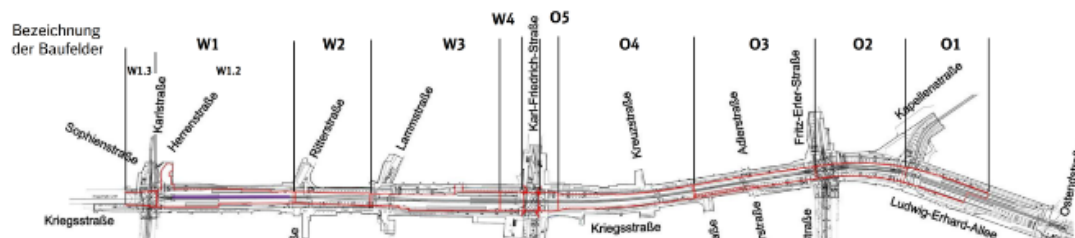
Grundriss mit Bezeichnung der Bauabschnitte
